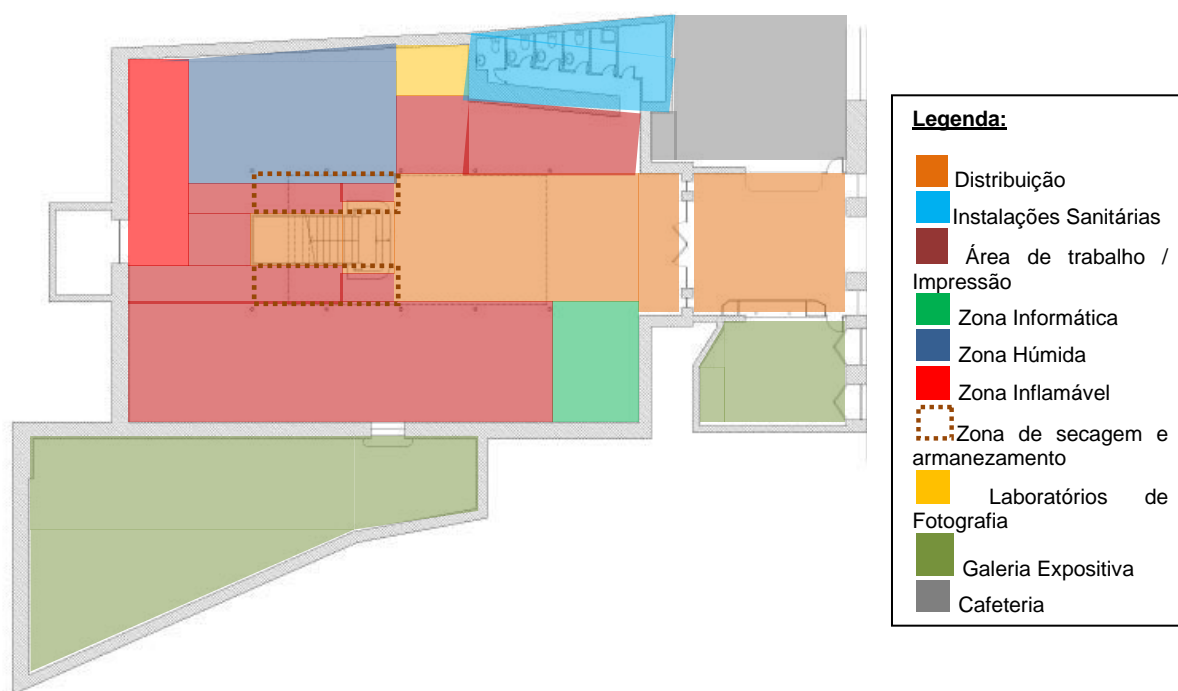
Fundação CIEC-planta, piso térreo ^[39]
